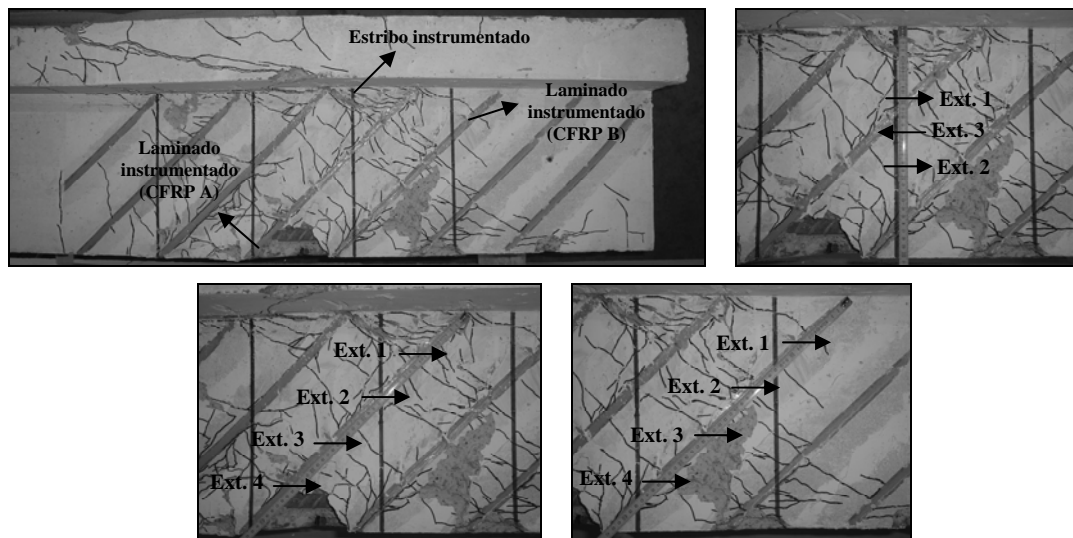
Localização dos extensómetros no laminado e estribo instrumentados da viga 4S-7LI45-C.
